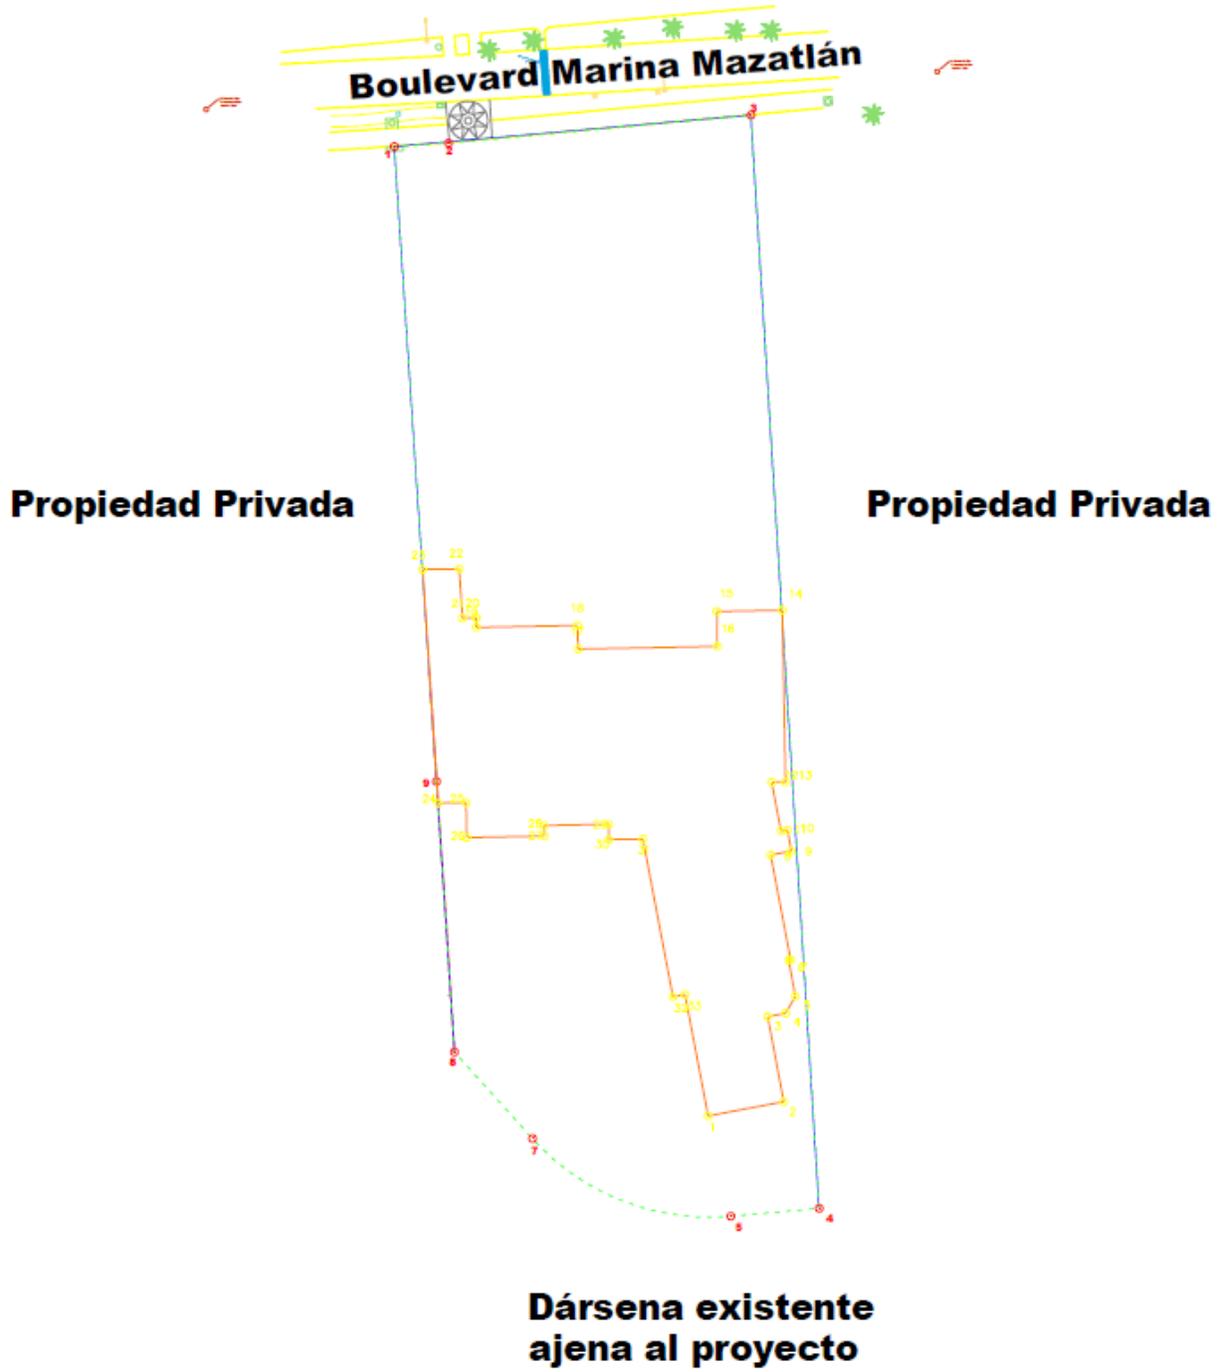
Polígono de sótano, donde se sentará la planta baja del edificio
